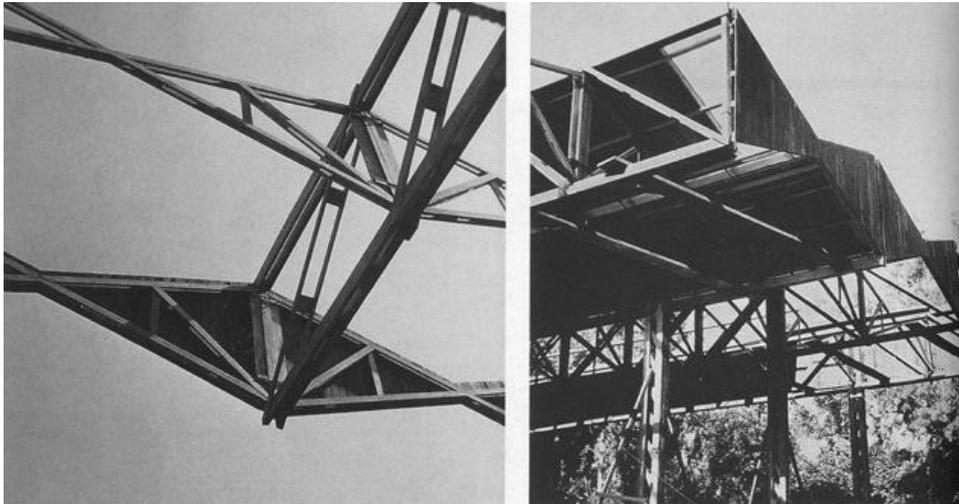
Pabellón Prov. de Tucumán. Detalles constructivos
